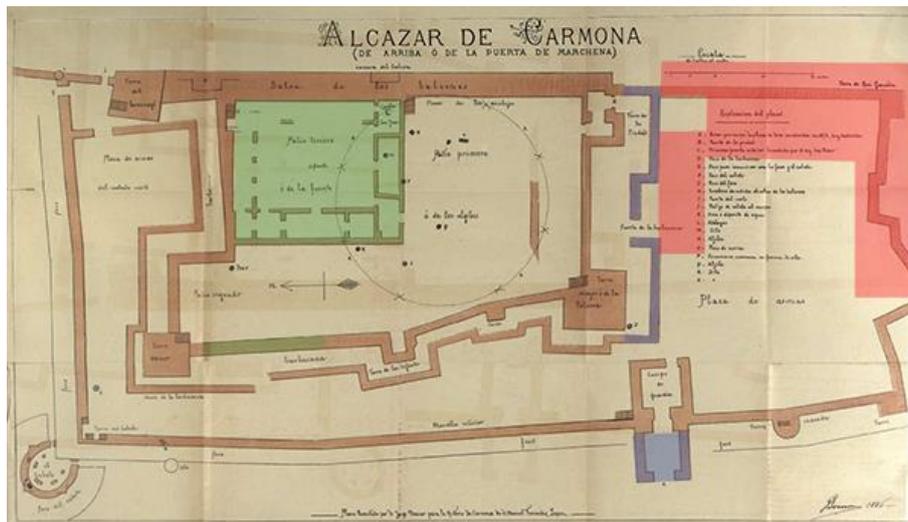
Conjunto Histórico del Alcázar del Rey Don Pedro.
